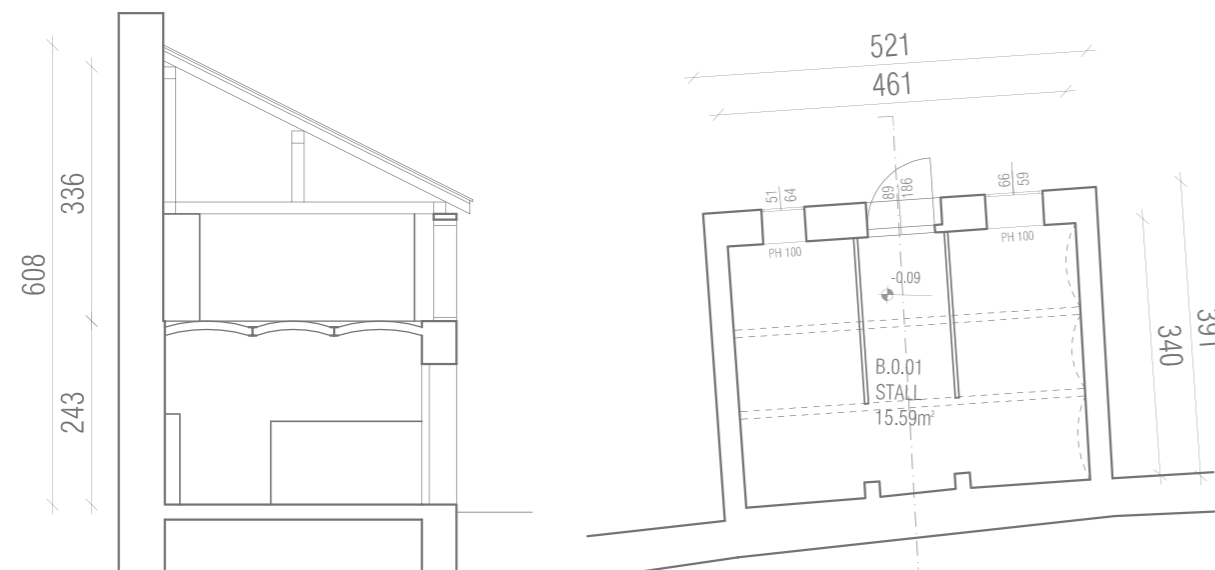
Gebäude B Einreichplanung aus dem Jahr 1912
